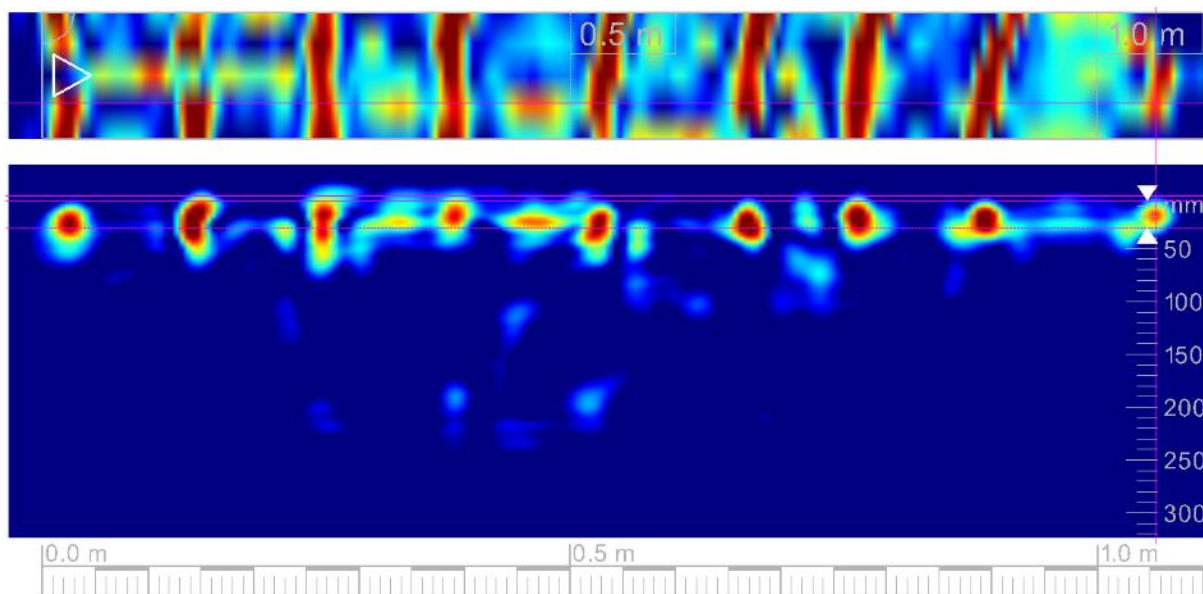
Sken rozdělovací výztuže klenby – patrná výztuž kolmá na osu mostu s roztečí 200-220 mm, krycí vrstva betonu 5-15 mm
